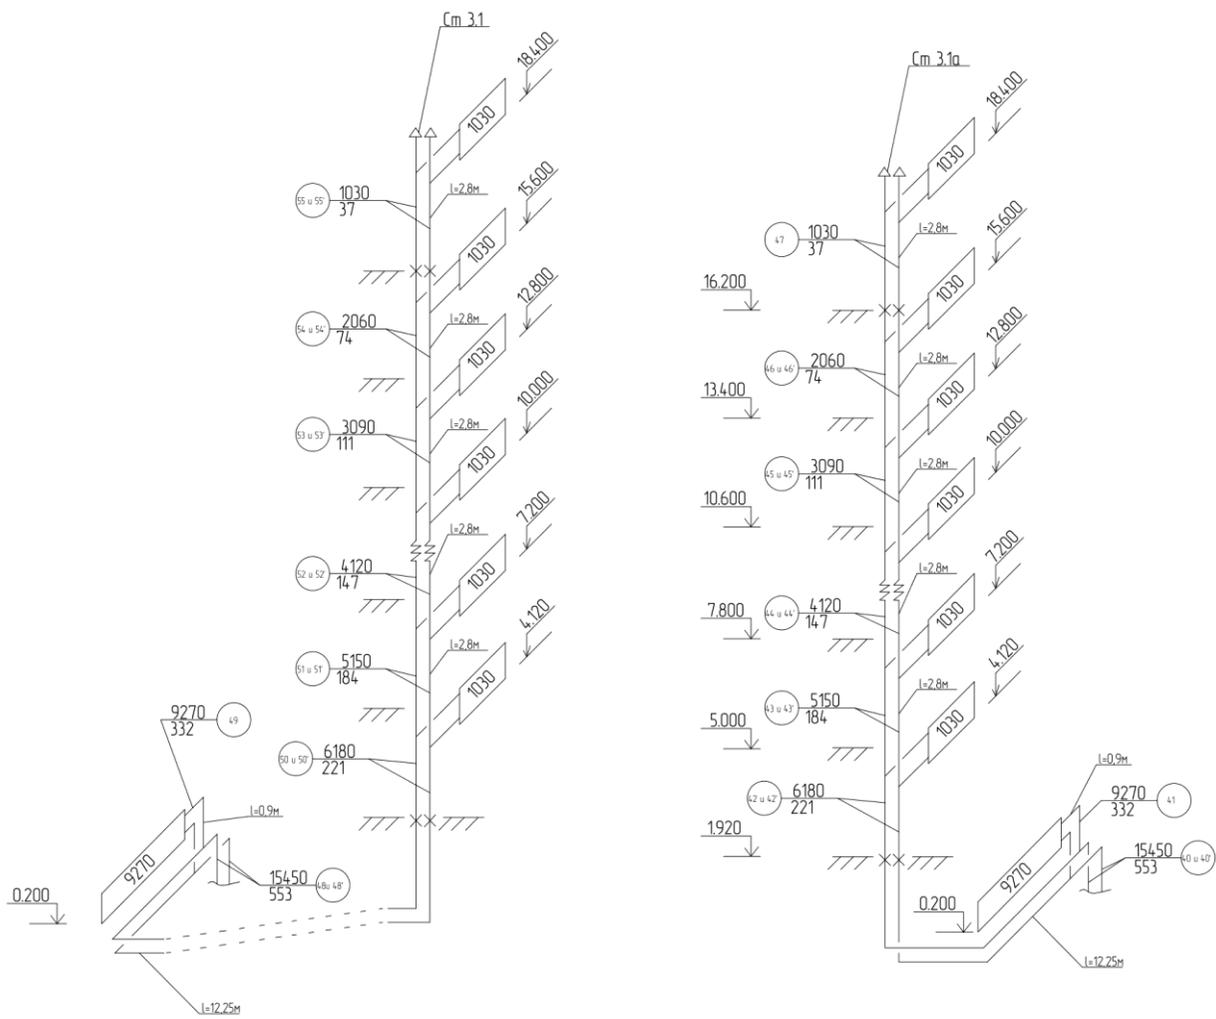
Расчетная схемы стояков 3.1, 3.1а
